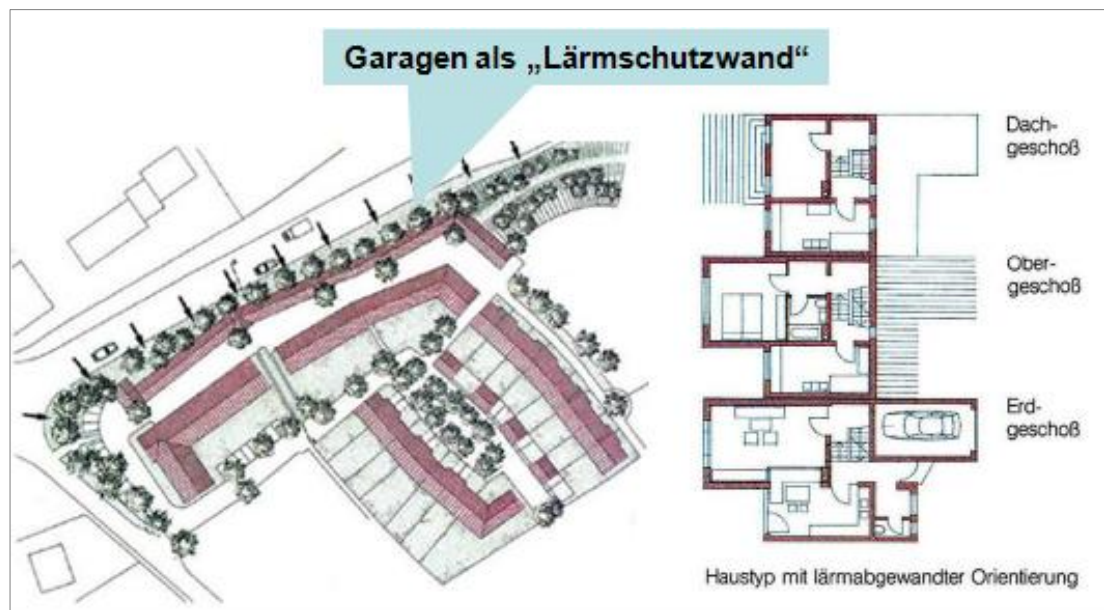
Lärmschutz durch Baustruktur und Grundriss
